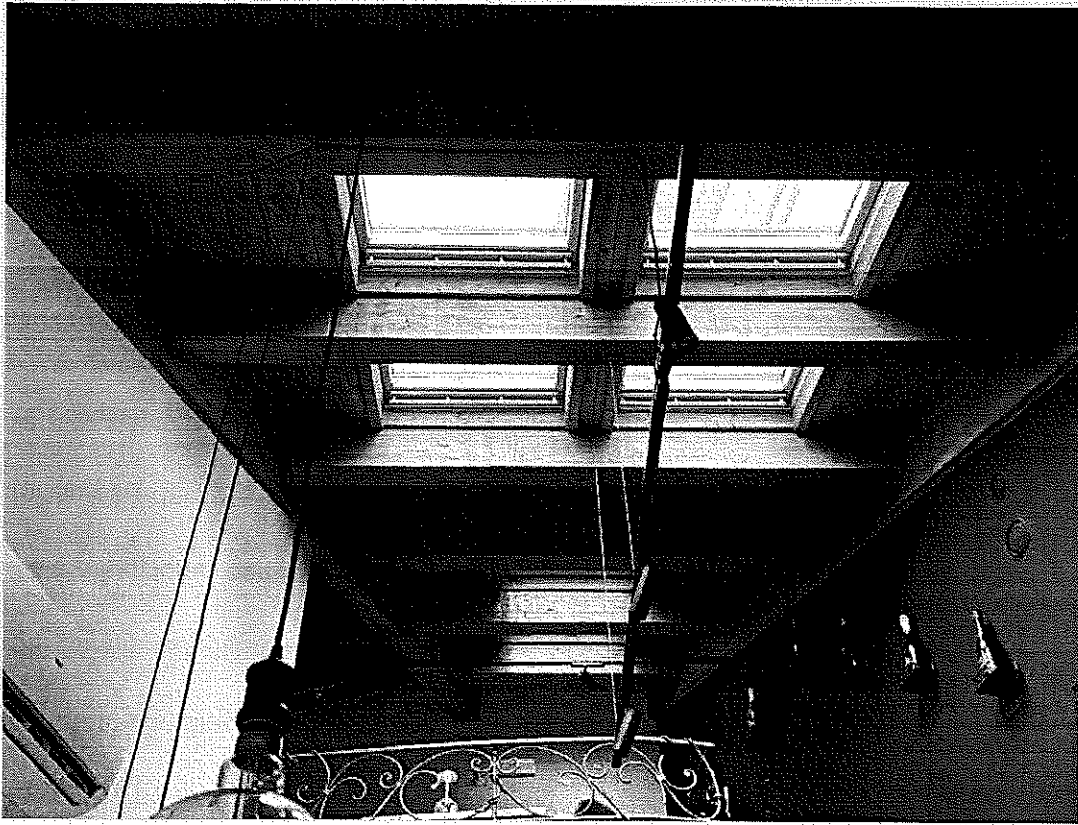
ALONI SU TRAVI SOFFITTO CAUSATE DA INFILTRAZIONI
